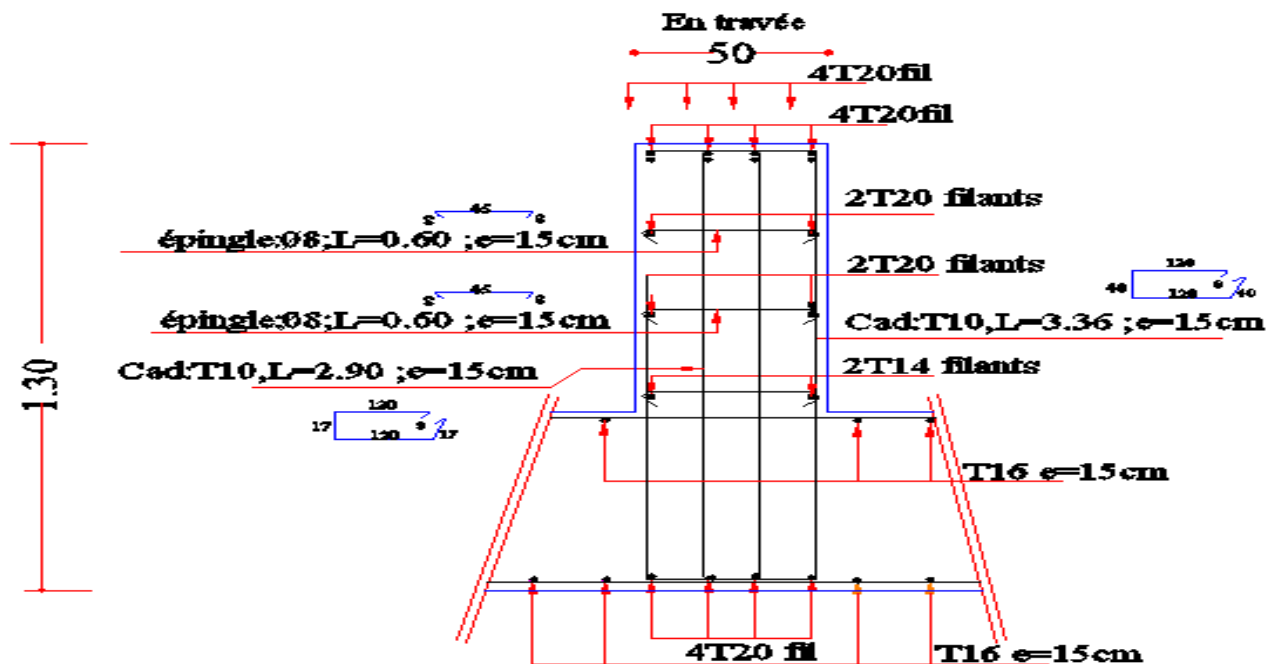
Ferrailage de la nervure en travée et la dalle du radie
